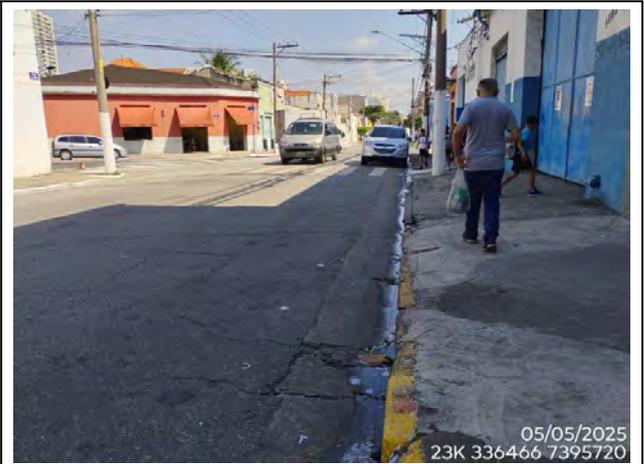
Vista geral da área do traçado na rua Nicolau Barreto.
